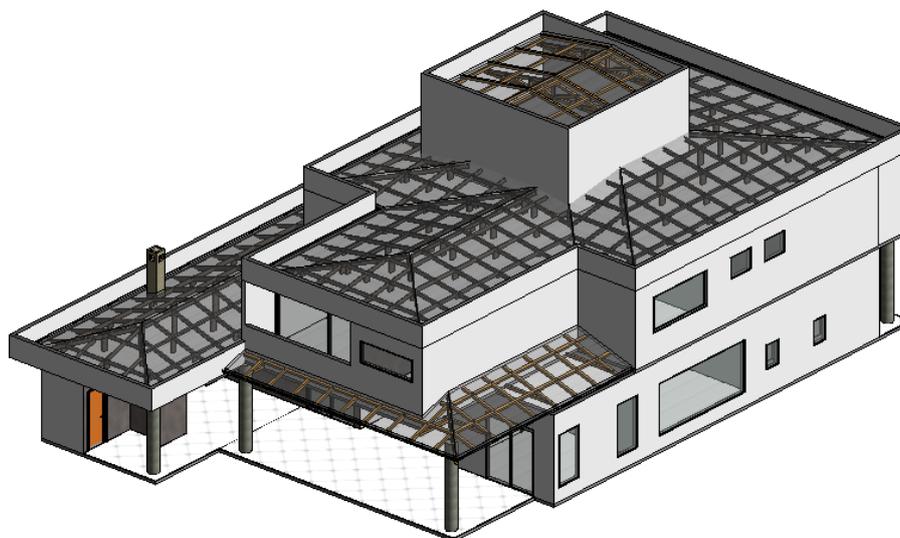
Telhamento com Transparência Possibilitando a Visualização dos Elementos Estruturais do Telhado
